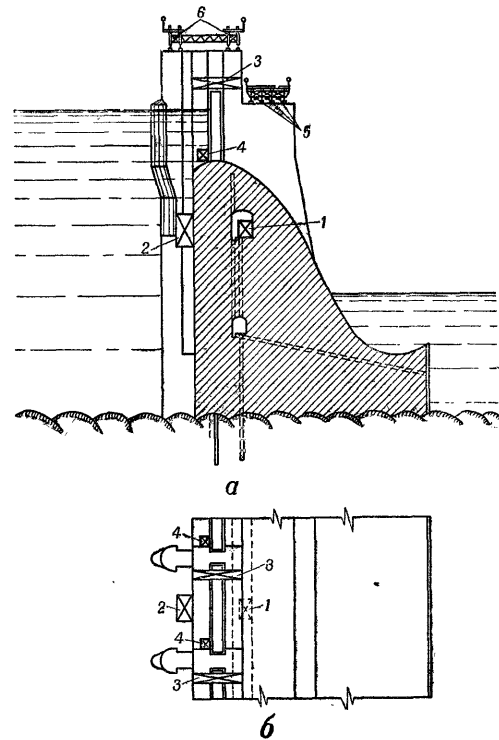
Подрывание бетонной плотины с массивным водосливом:
